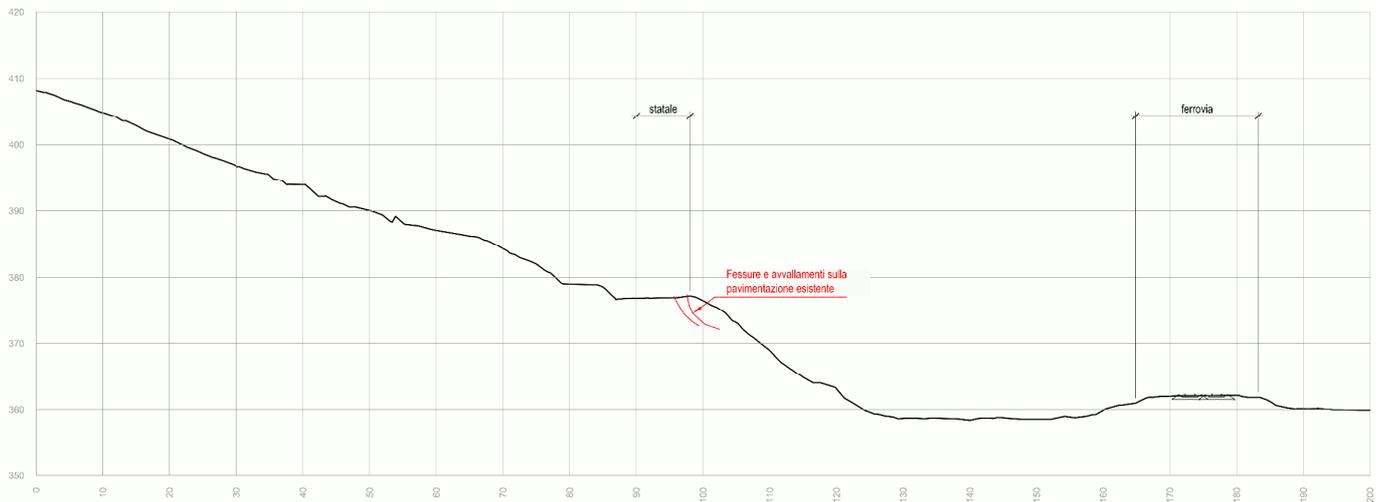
Viabilità SS n.90 e instabilità del ciglio stradale
